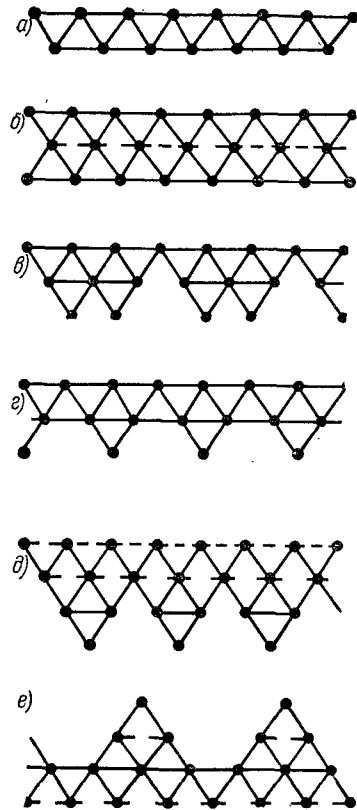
Варианты поперечных сечений перекрестно-стержневых конструкций (а—е)
